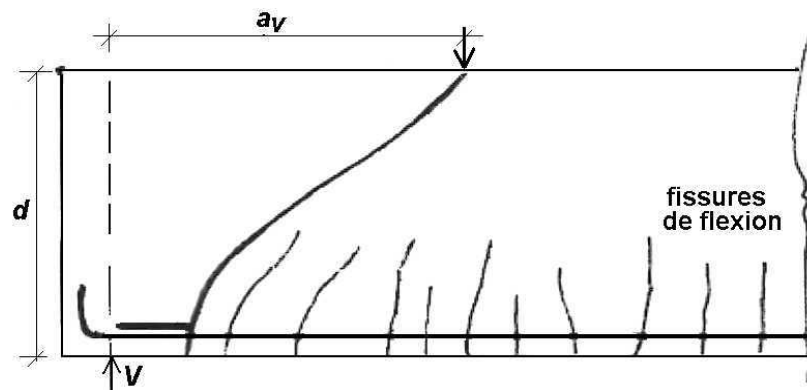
Etat de fissuration à la rupture d'une poutre avec  $(2.5 < a/d < 6)$  [10]
